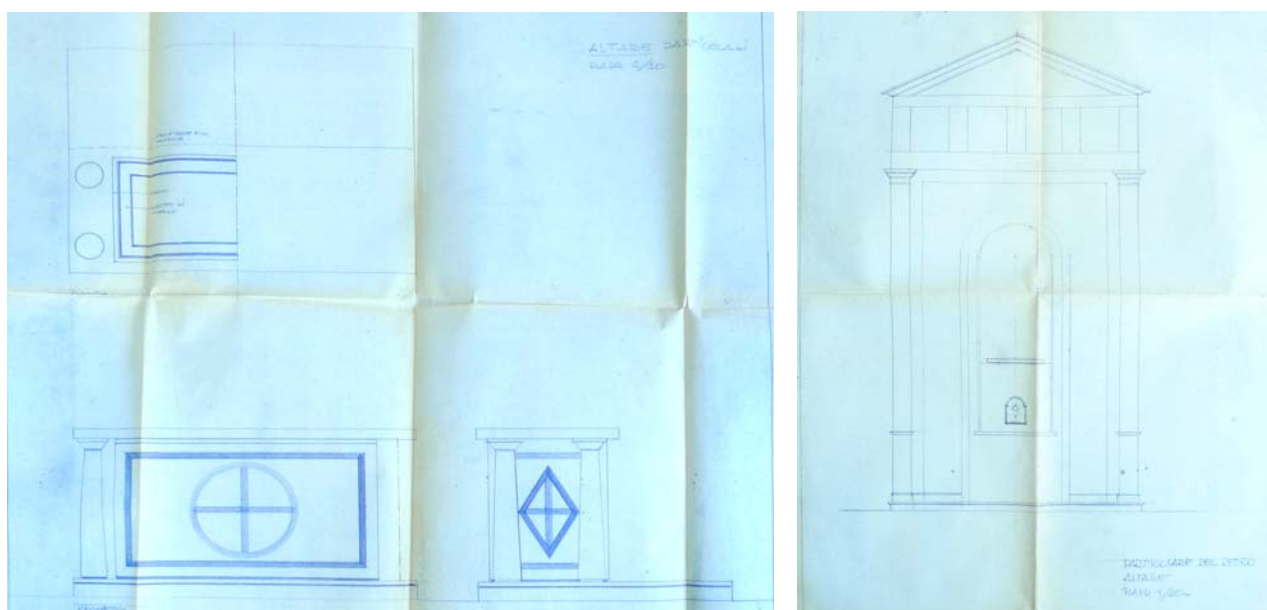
M. Canino, altare e tabernacolo in San Pietro in Cattedra (Archivio Parrocchia San Pietro in Cattedra).
